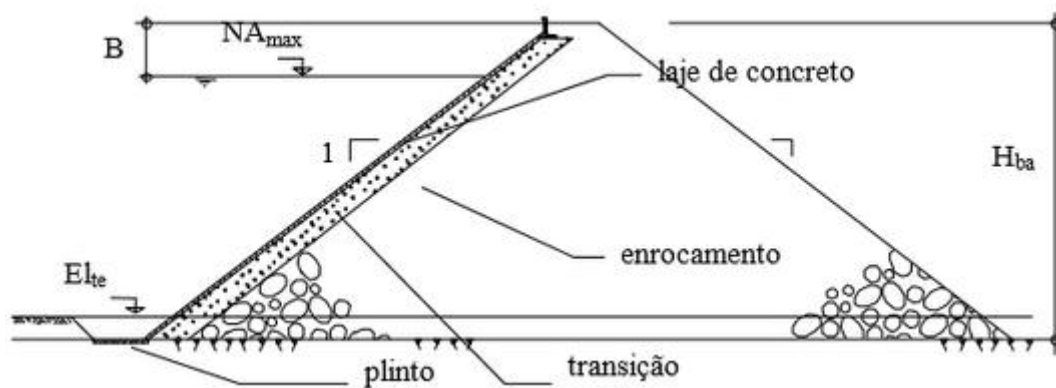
Barragem de enrocamento com face impermeável de concreto (Assis, 2014)
